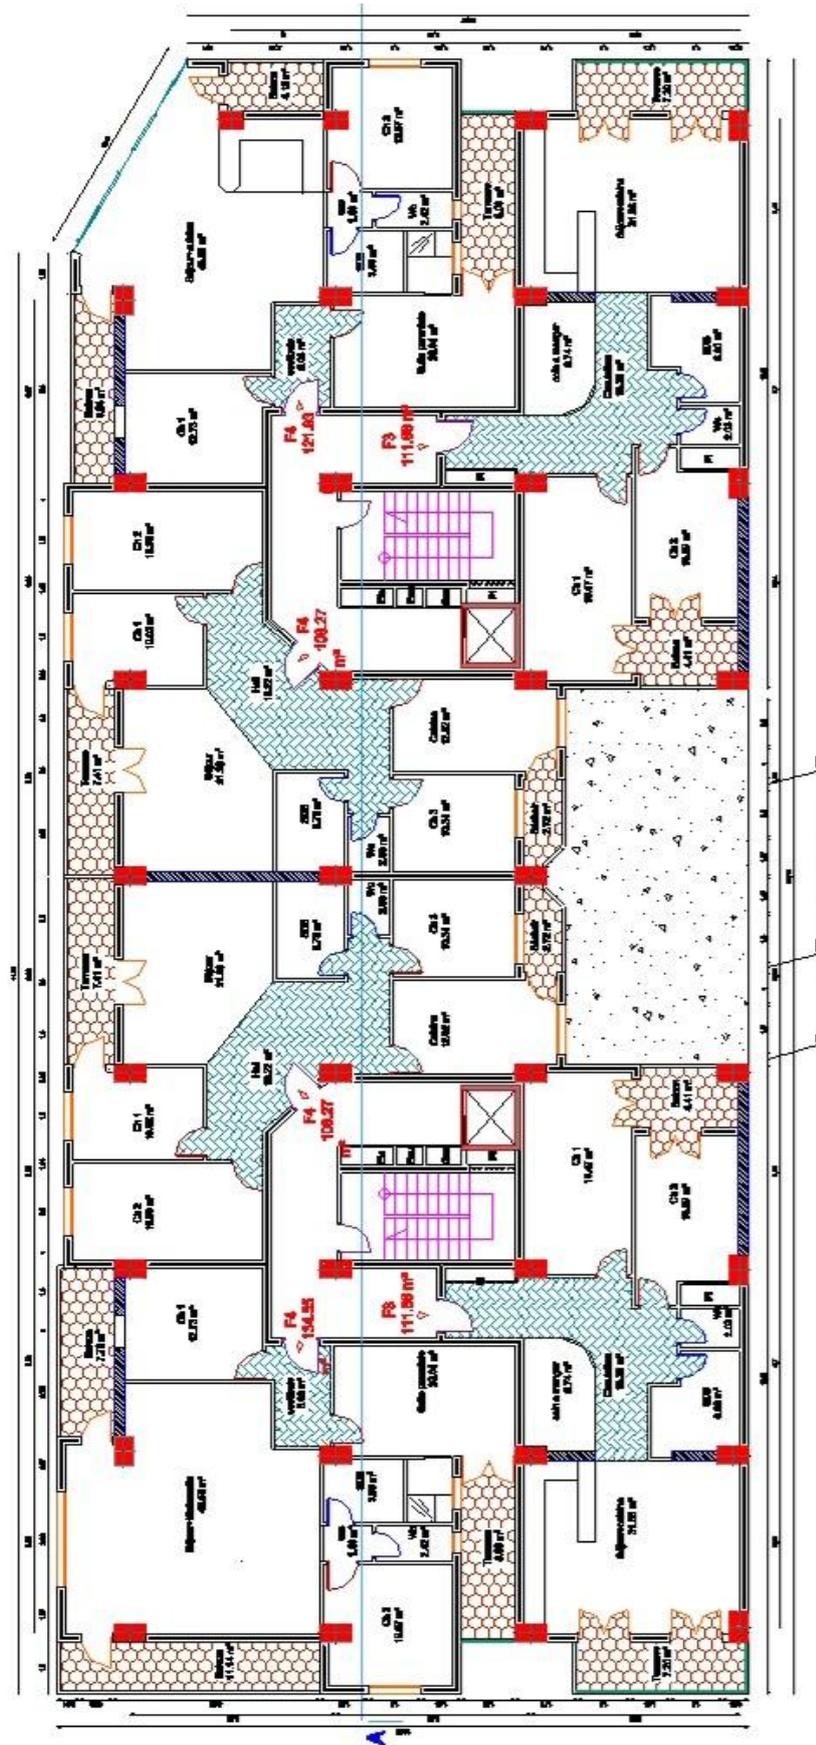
Plan de sol niv +10.20 à +16.32
